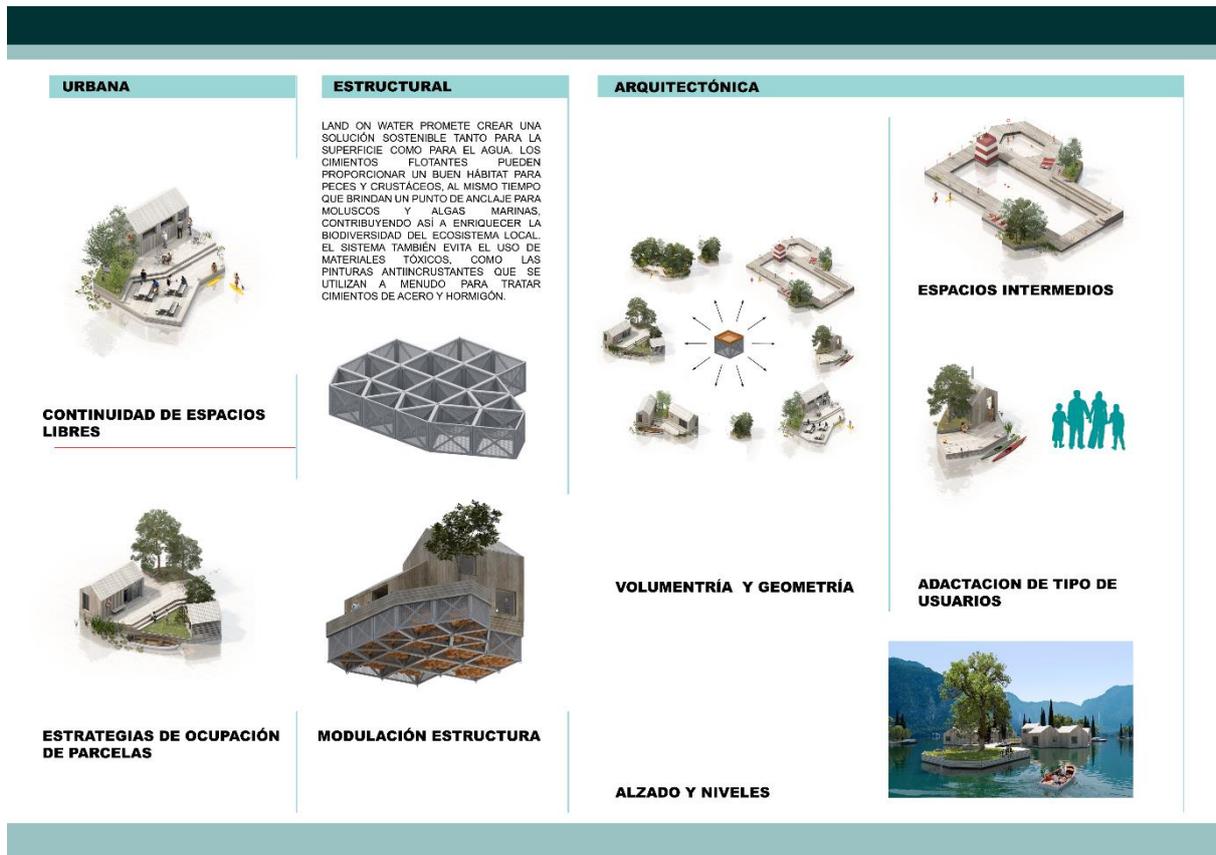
Sistema modular sostenible para construir arquitectura flotante, diseño.
